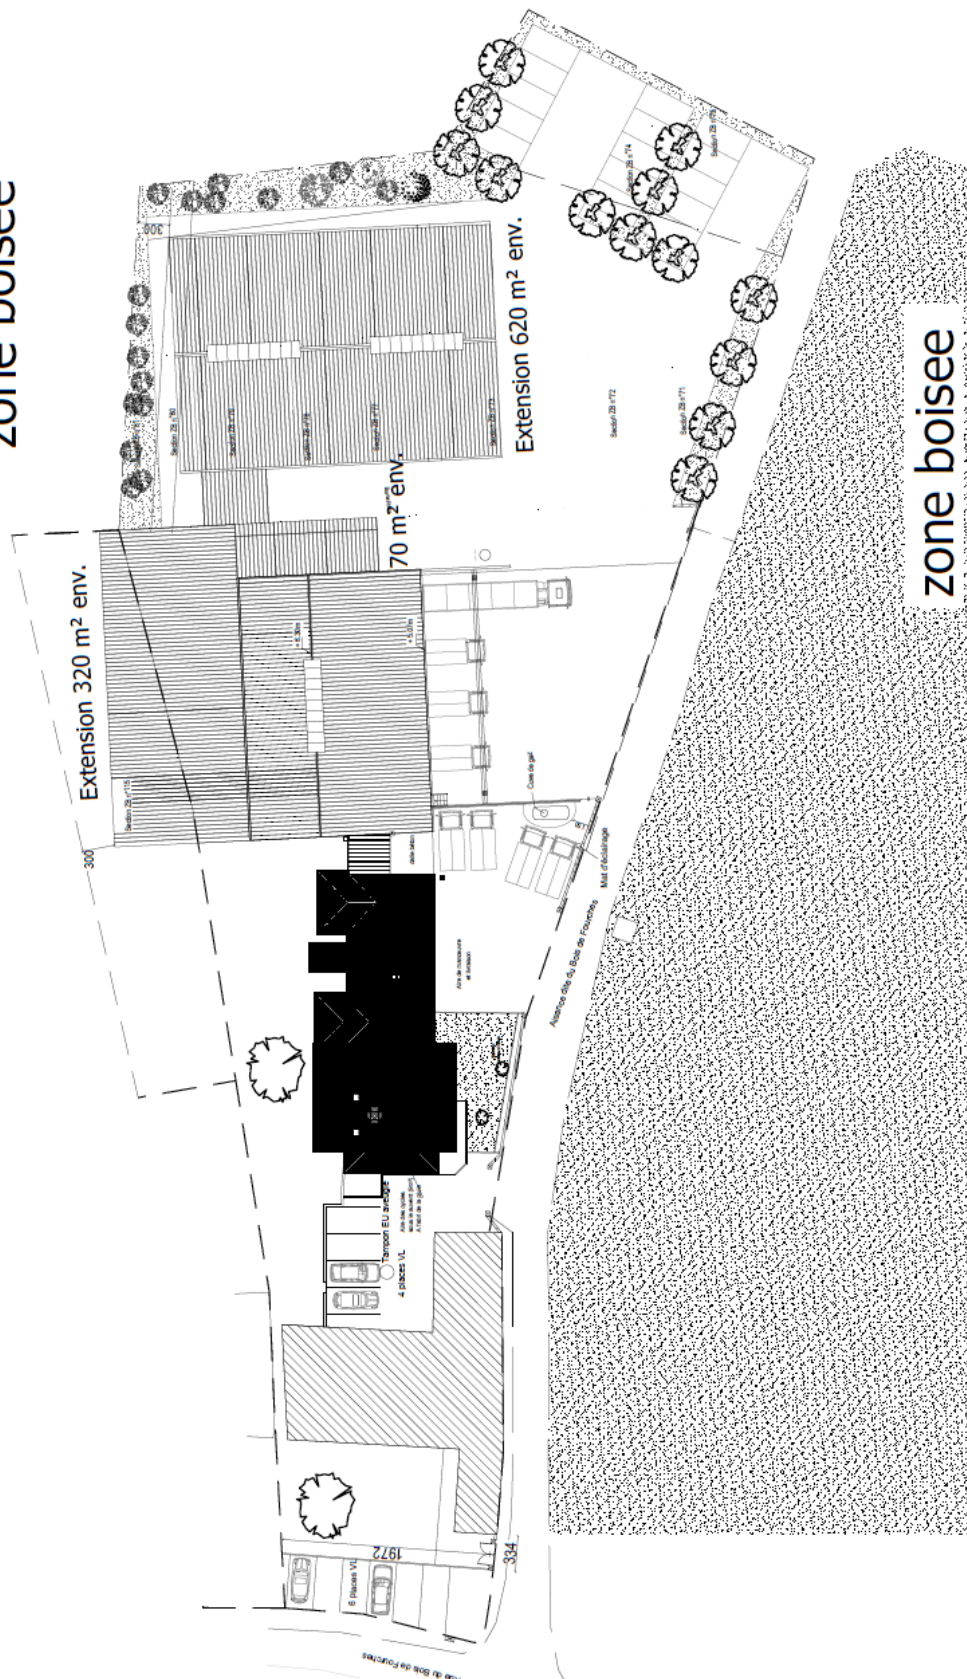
Plan masse du site de l'entreprise MG Réception (Claude Ferrari)
